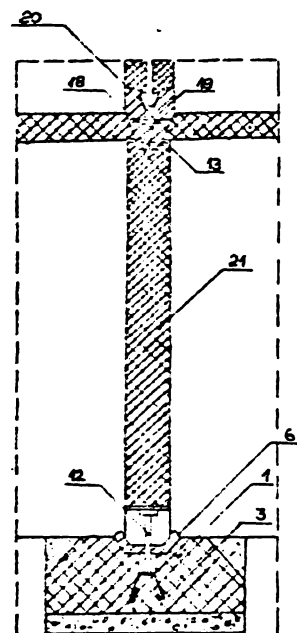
Secțiune verticală prin infrastructură, varianta II
